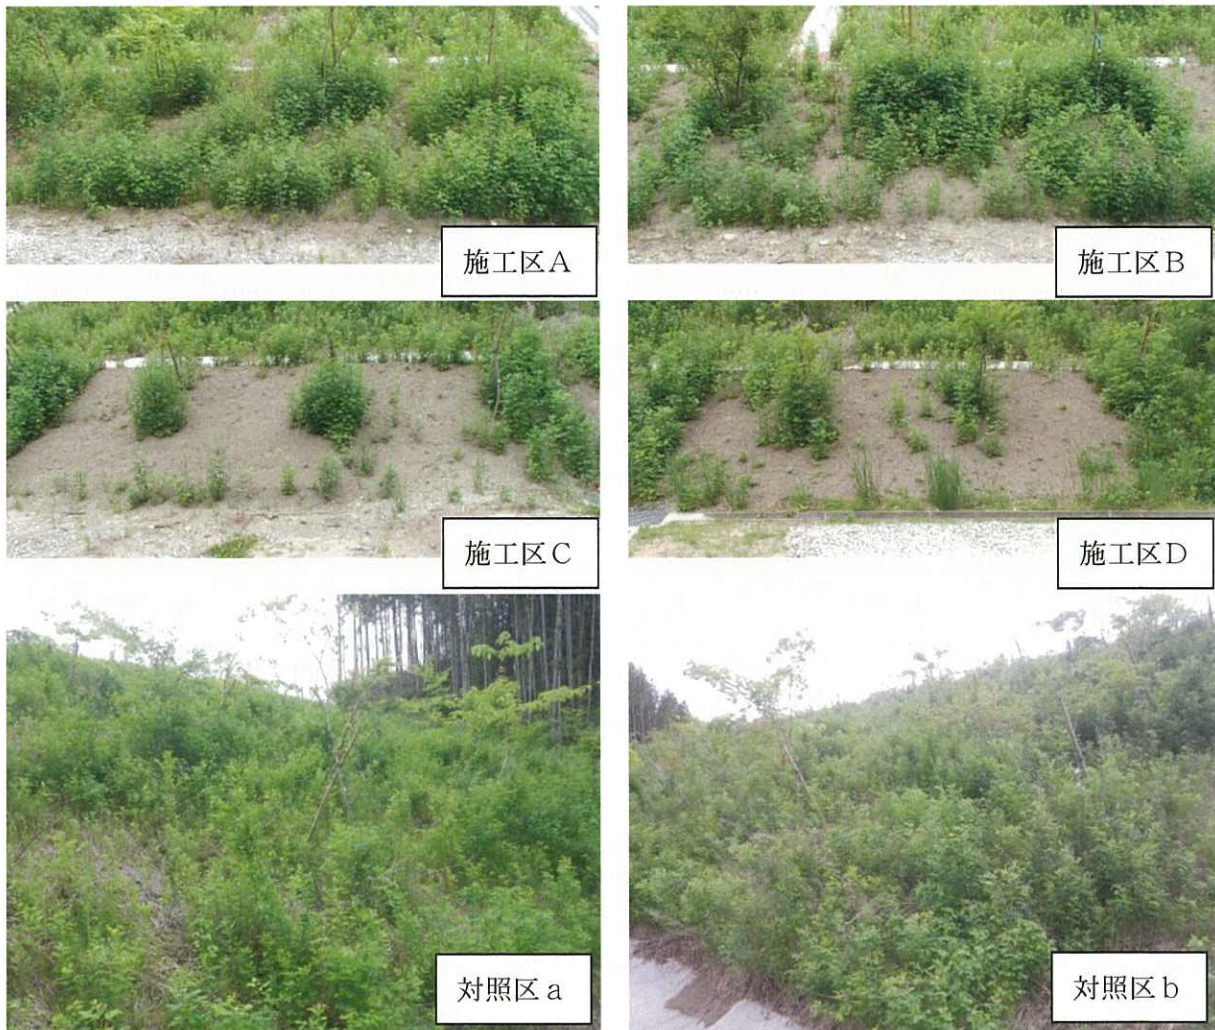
試験施工区の状況 (平成 26 年 6 月 5 日撮影)
